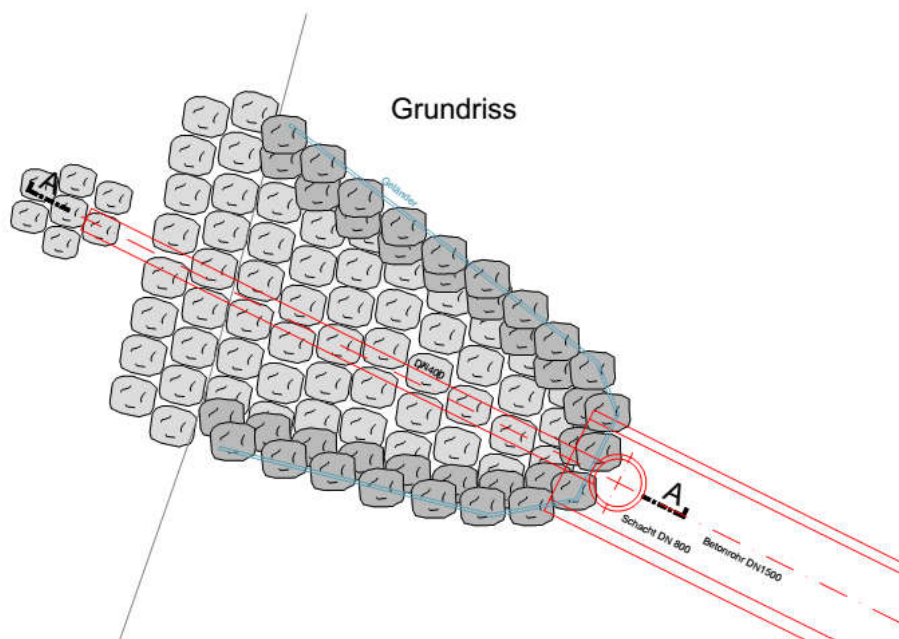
Auszug Plan 104 Einleitbauwerk
